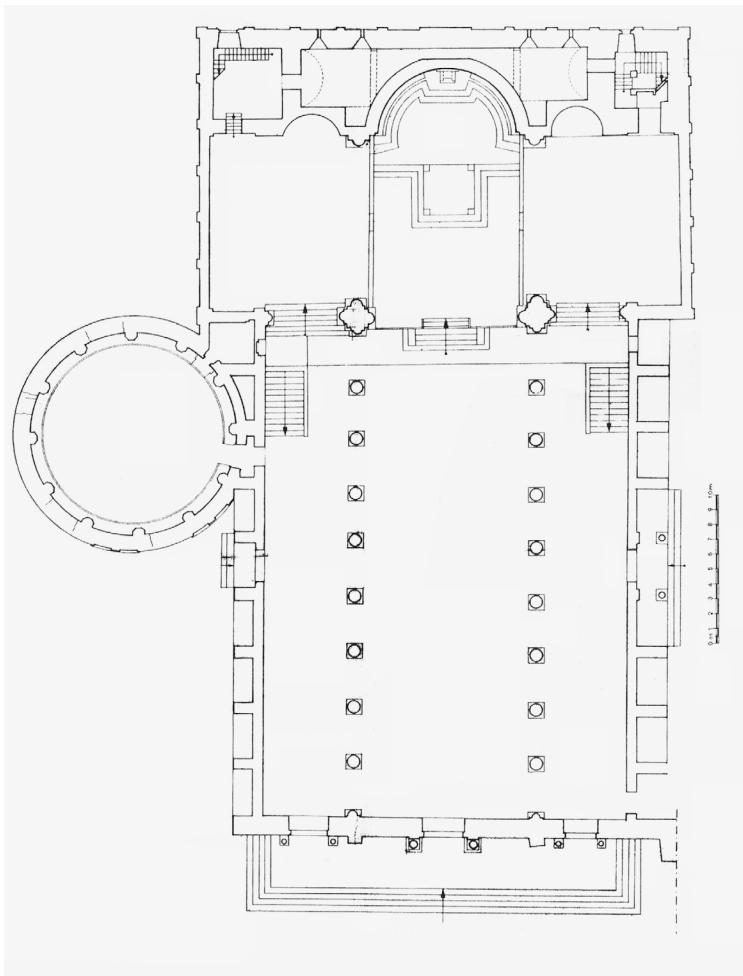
| Grundriss der Oberkirche der Kathedrale San Sabino, Bari, 1:300 (KAPPEL, San Nicola, Abb. 112).
